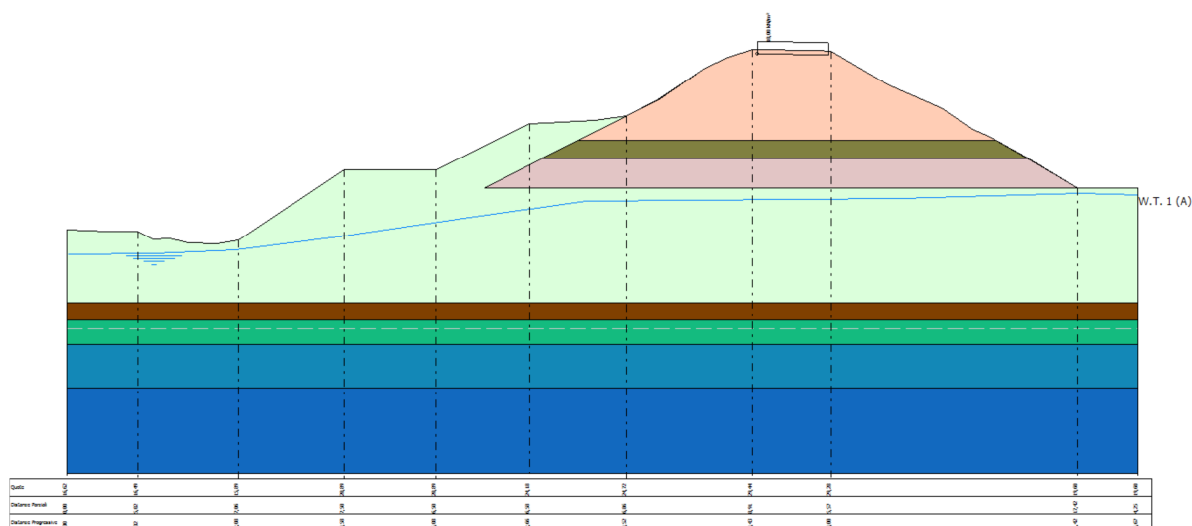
Schematizzazione della sezione oggetto di verifica di stabilità
